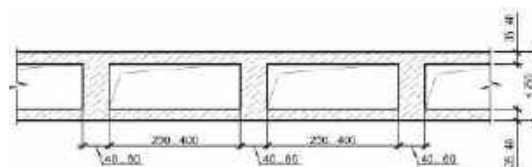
Конструктивна схема перерізу монолітного перекриття з пустотними вкладишами.
